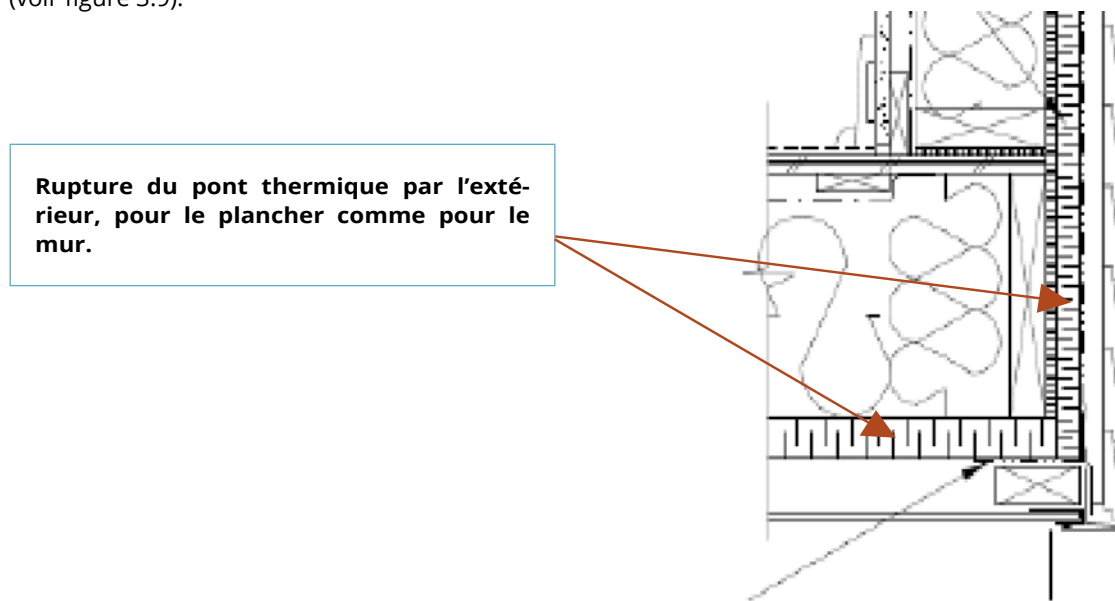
DÉTAIL TYPIQUE DE LA JONCTION ENTRE UN MUR ET UN PLANCHER / SOURCE : SHQ
